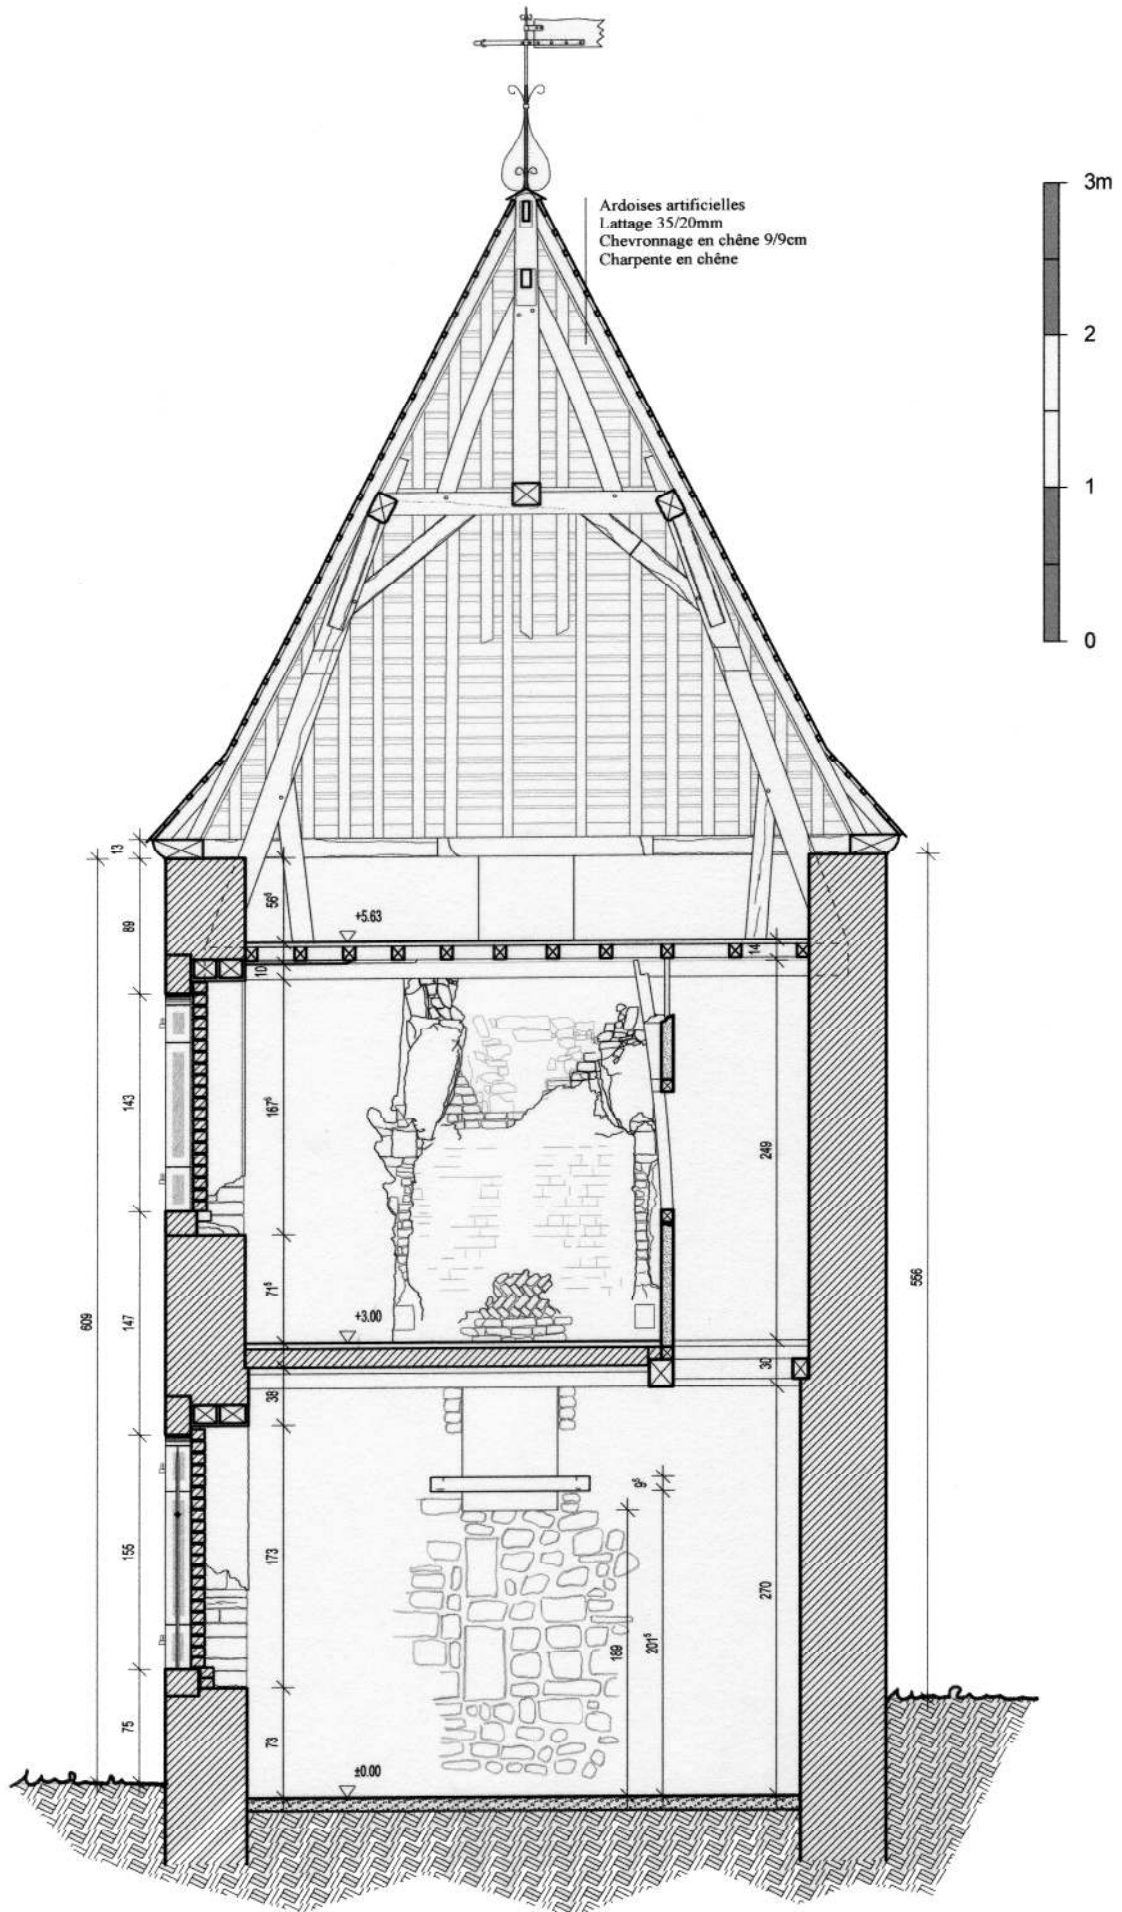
Pavillon. Vue en coupe AA'. Ech. 1/50°. Situation existante. IG 2003.
